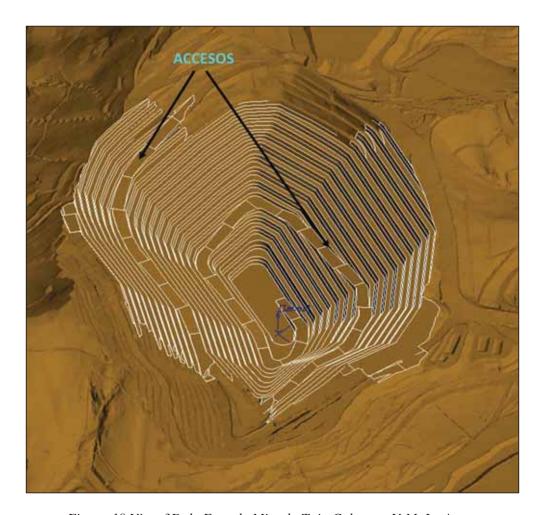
Vista 3D de Fase de Minado Tajo Calaorco U.M. La Arena
